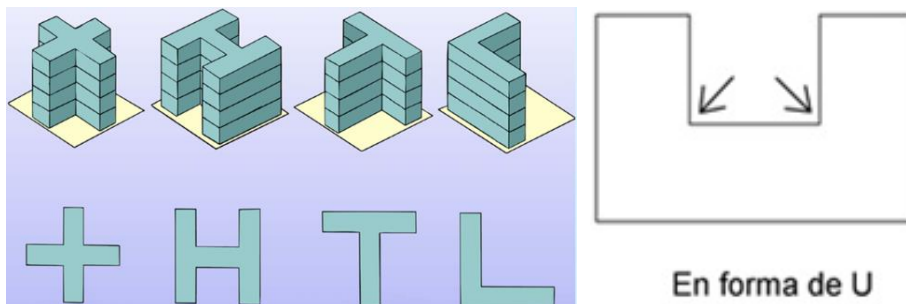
Irregularidad en Planta: Configuración en Planta.
